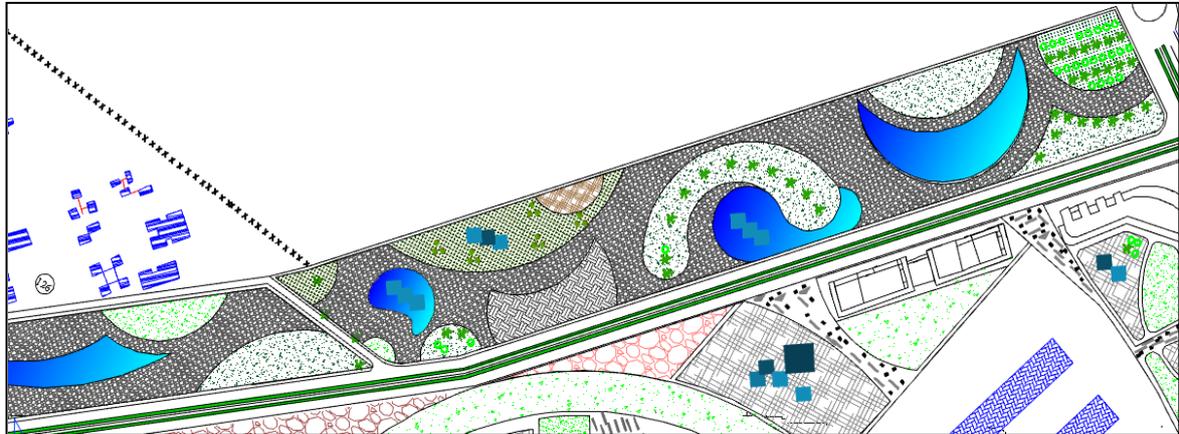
Vue en plan du jardin linéaire (entrée ouest de la ville)
